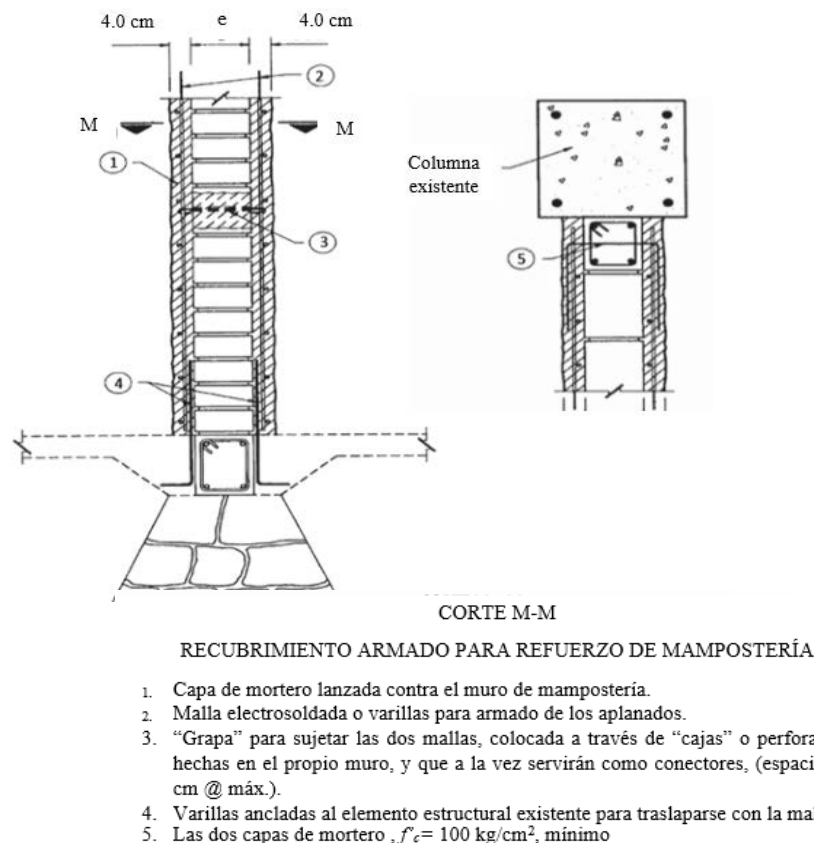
Detalle del anclaje mallas de alambre o de acero de refuerzo en dos caras del muro (De la Torre, 1995)
